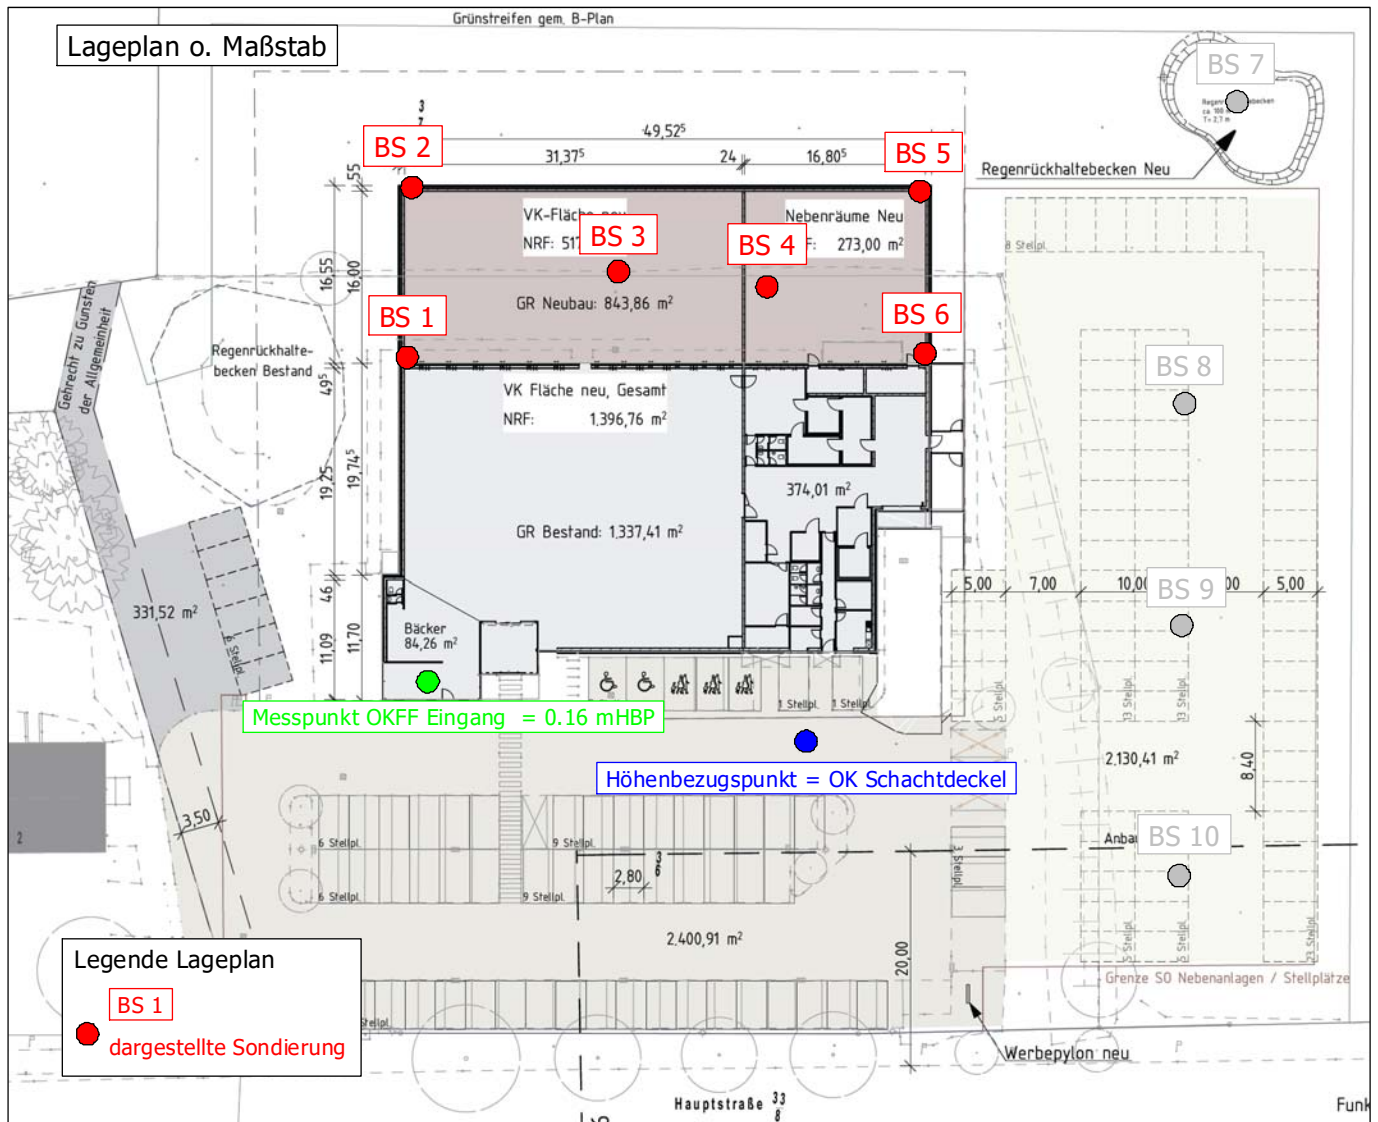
Lageplan s. Anl. 1.1 (o. M.)
